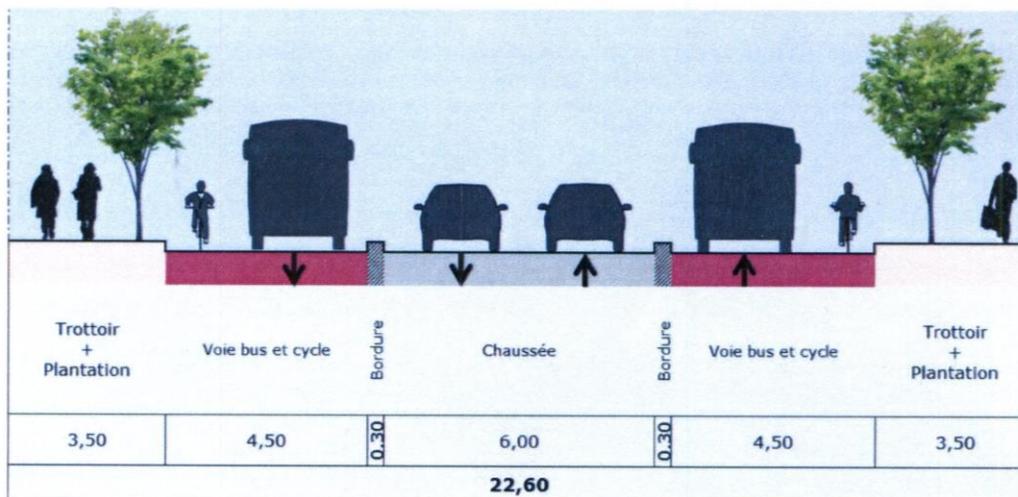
Coupe type pour l'insertion d'un site propre bilatéral
